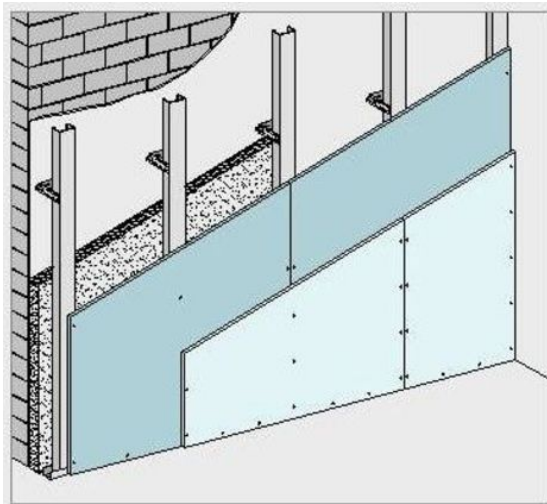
Sección fachada con trasdosado autoportante(Fuente:knauf)
